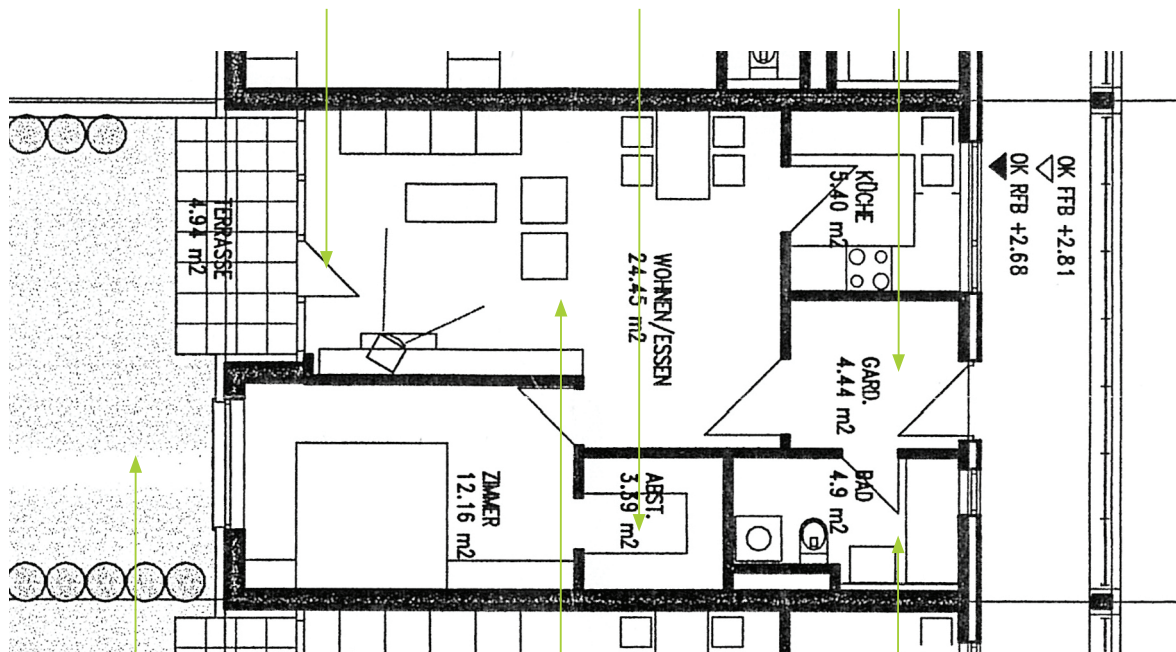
Grundriss 1. OG o. M., Grafik: Joseph Stiftung
